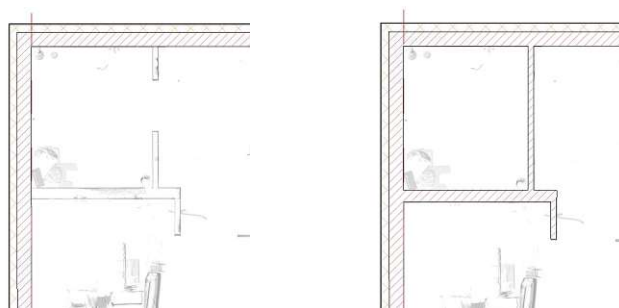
Modellierung der Innenwände im Grundriss auf Basis der importierten Modelliergrundlage, links vor und recht nach der Modellierung.
